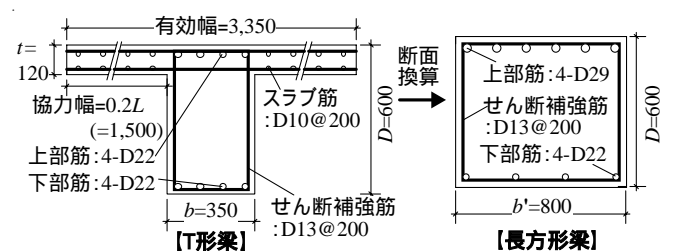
実大建物の T 形梁の長方形梁への換算 (単位: mm)
